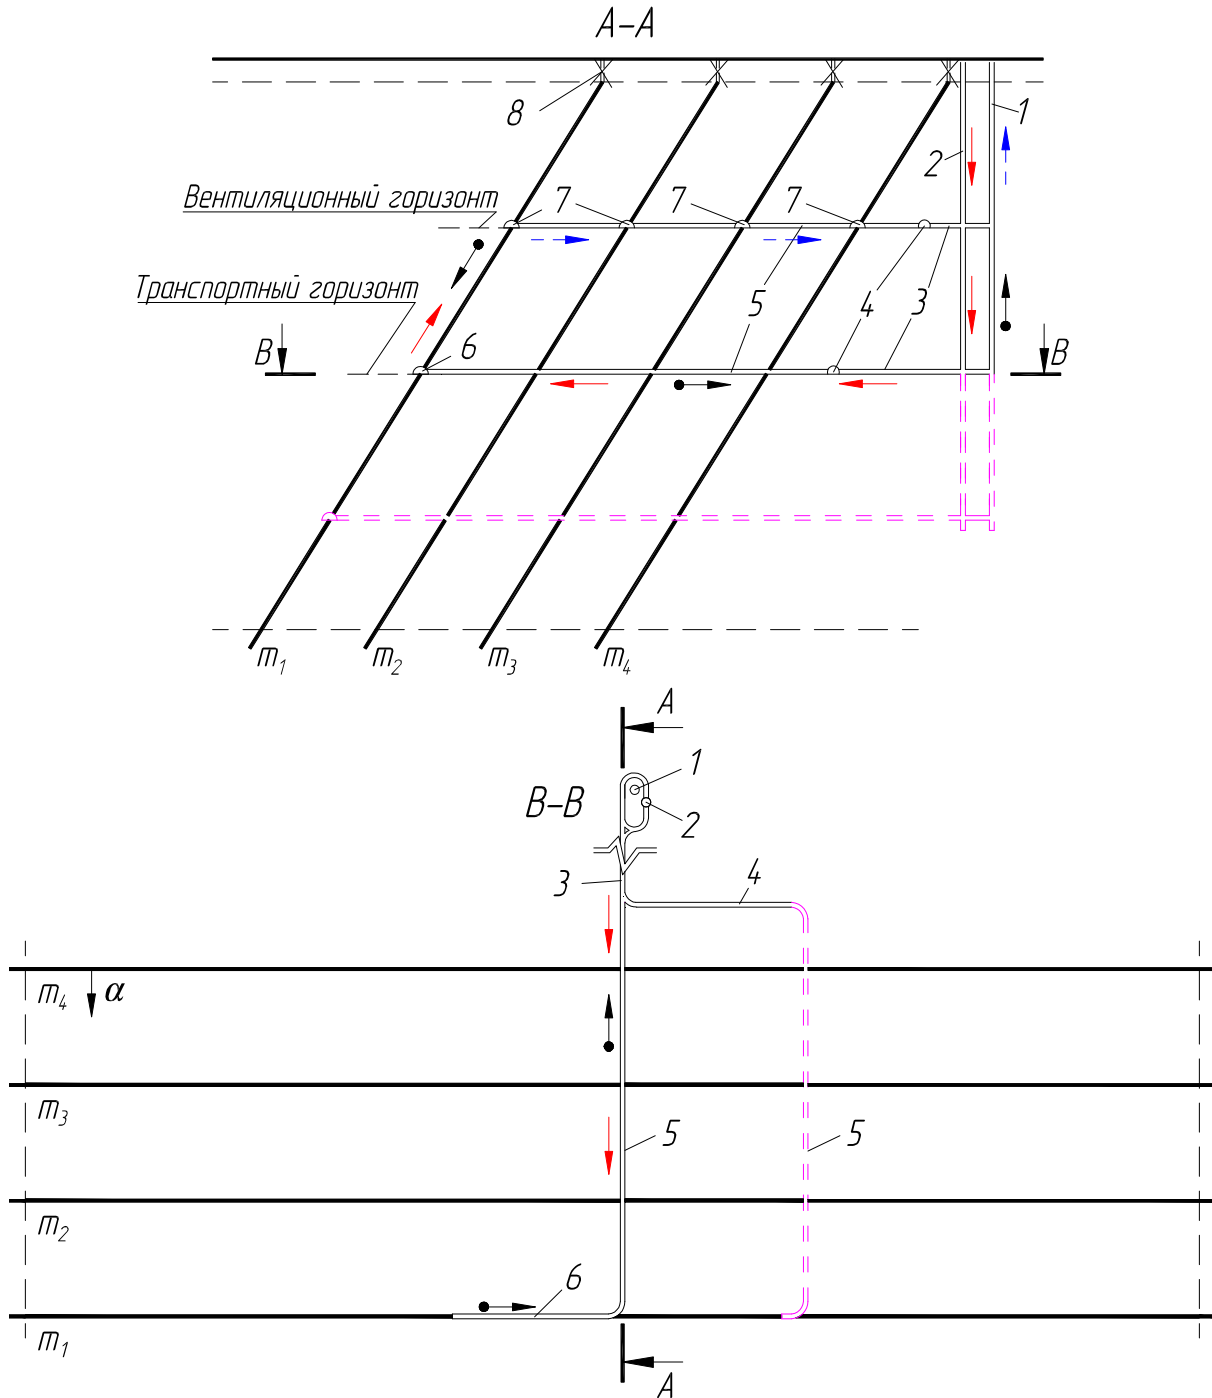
Схема вскрытия вертикальными стволами с этажными квершлагами:
